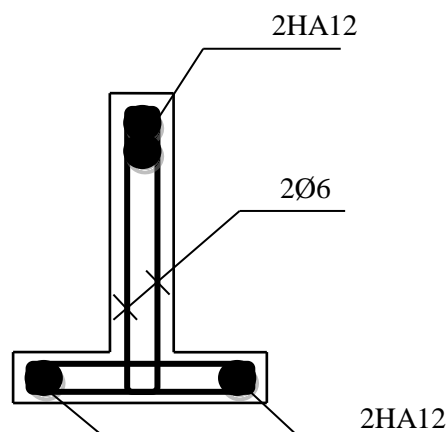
Ferrailage de la Poutrelle de terrasse type 2 sur appuis.
